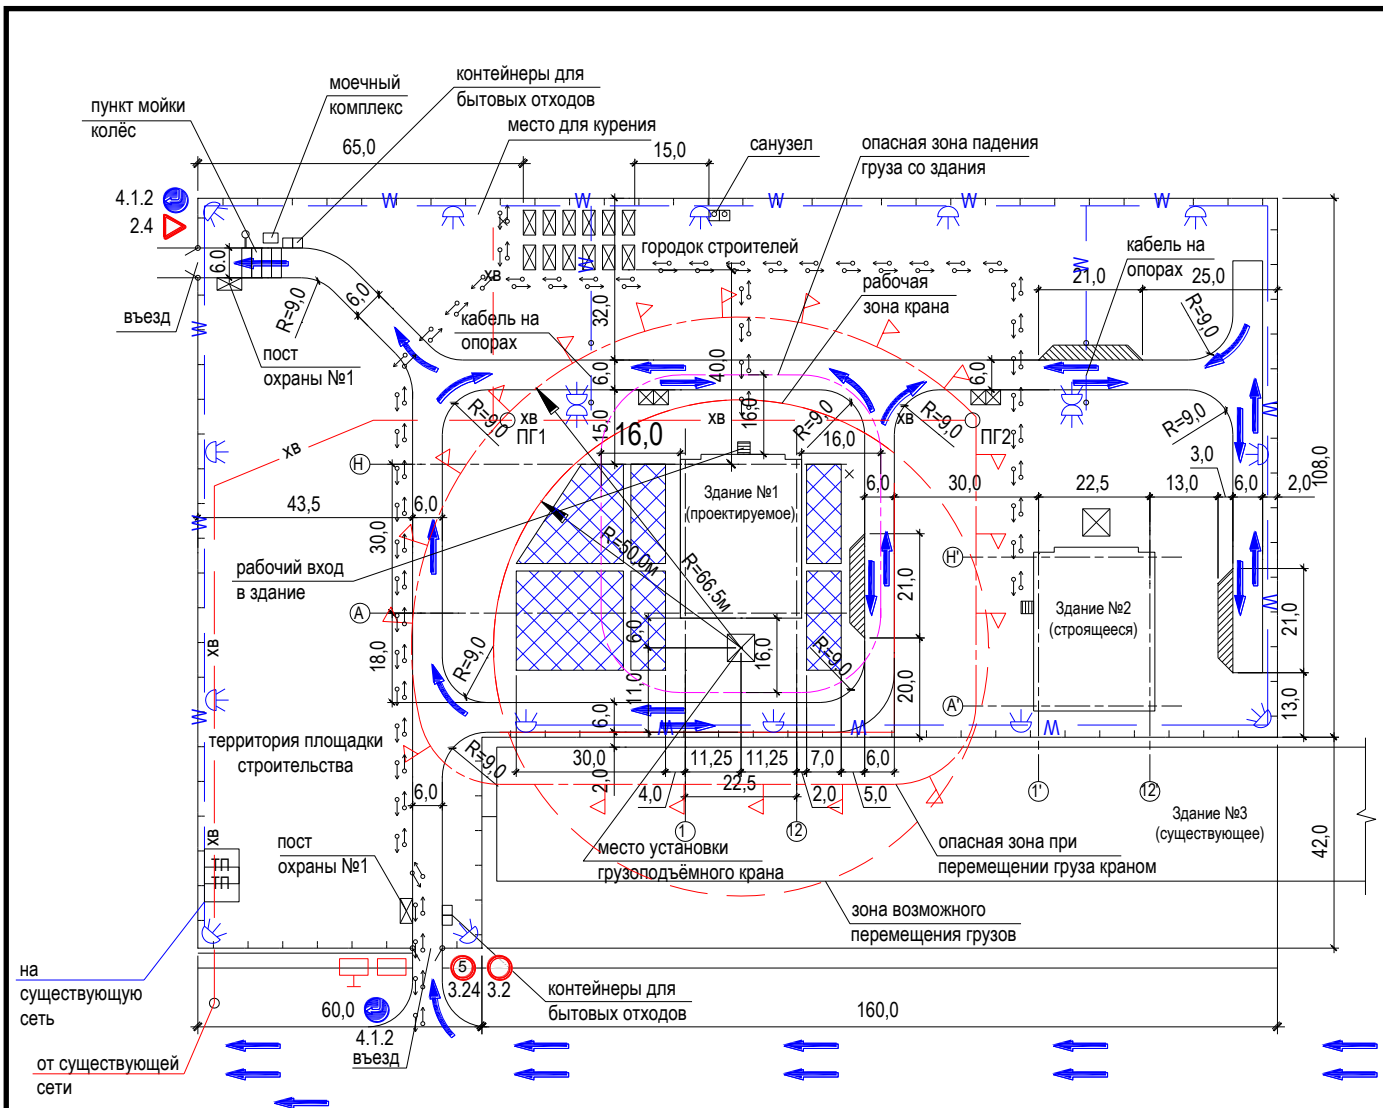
Схема сетей временного водоснабжения строительной площадки
